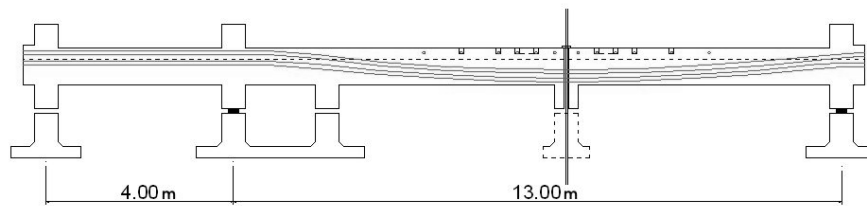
Ersatzbauwerk „Concerto“: Längsschnitt und Spanngliedführung
